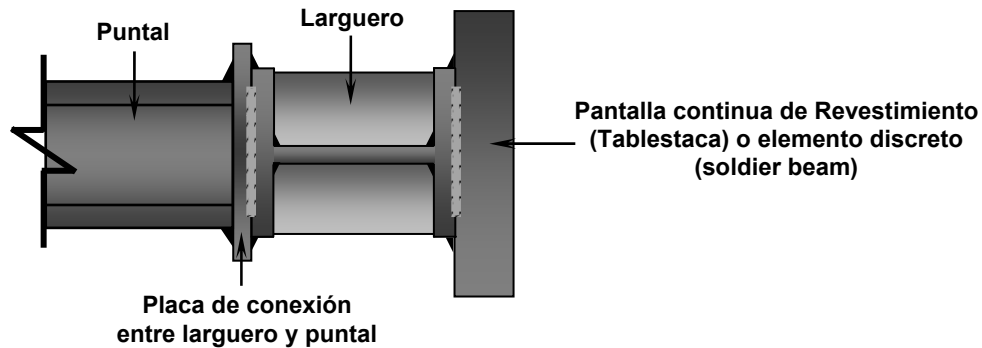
Puntal de acero estructural conectado a larguero o viga madrina.
